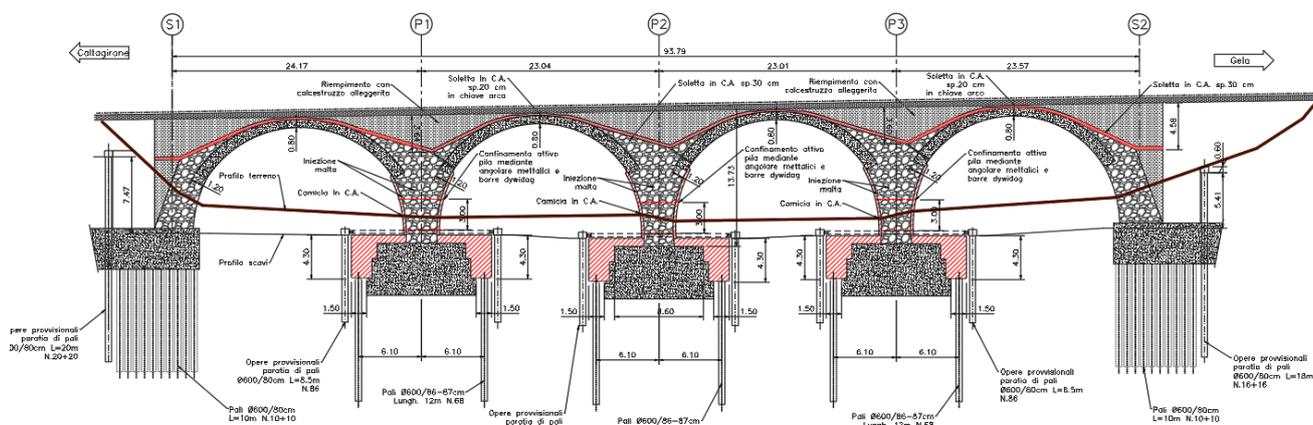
Sezione longitudinale viadotto tipo con quadro d'assieme interventi;
